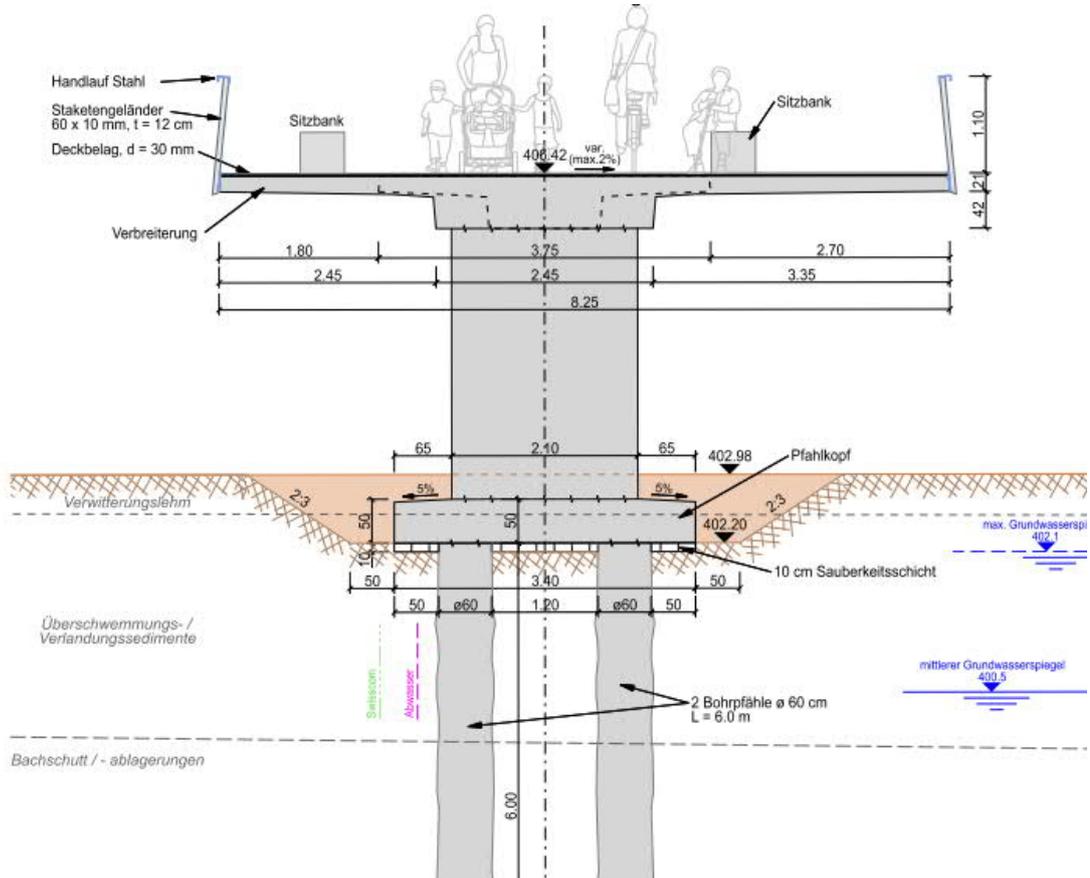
Kobelstege, Querschnitt Fundation Pfeiler 2
